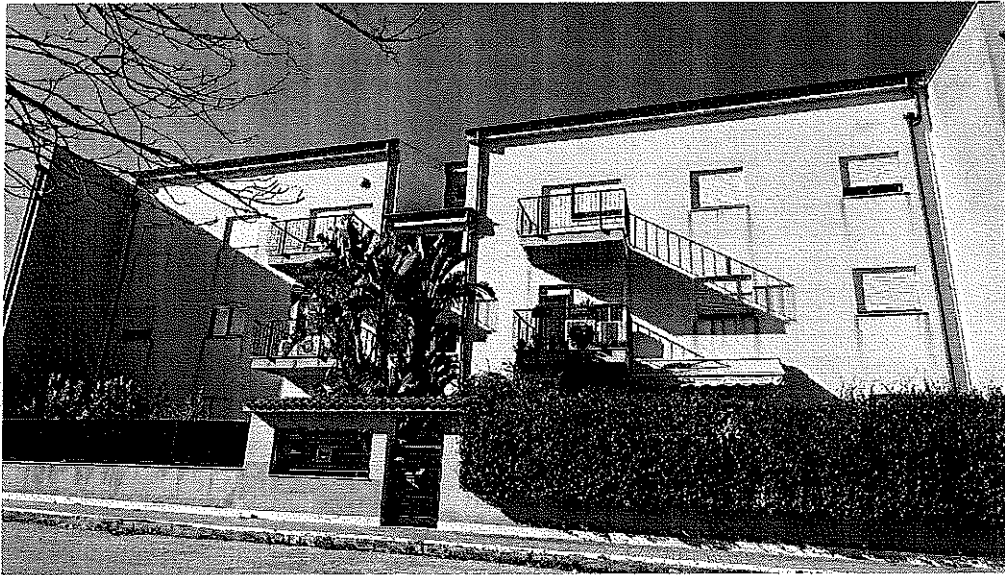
PROSPETTO VIA DON G. GIARDINA
